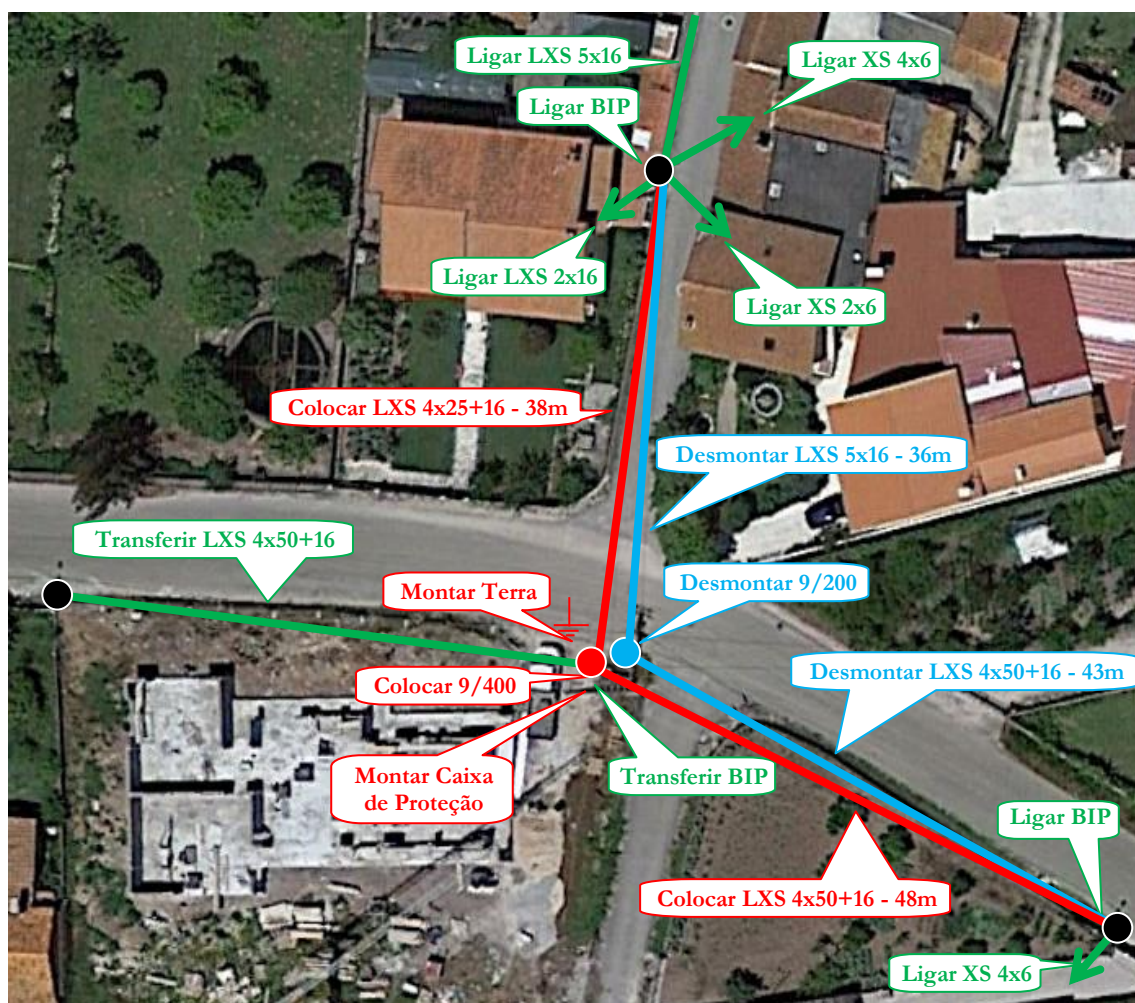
Exemplo de uma planta de localização de uma modificação de rede.
